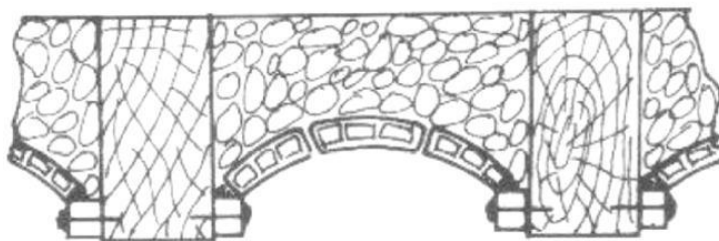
Esquema de forjado unidireccional de viguetas de madera y revoltones.
